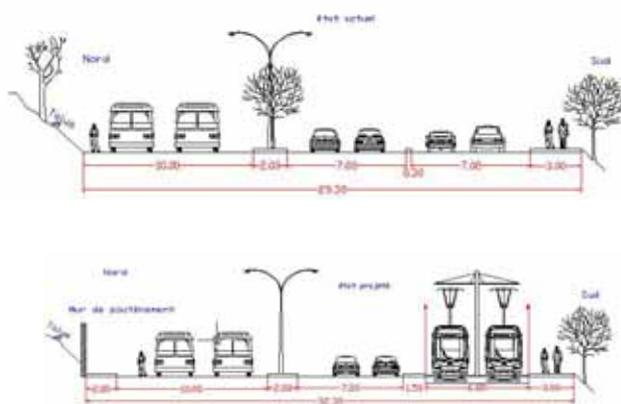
Implantation du tramway sur la voie de l'université Mentouri
